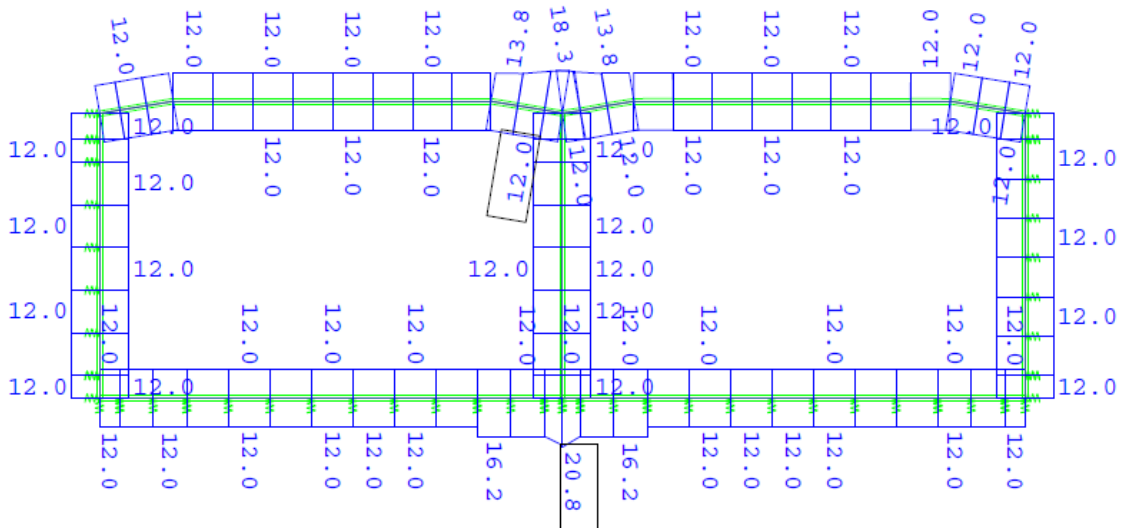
Biegebewehrung aus Lastfall nach dem Brand [cm²/m]
